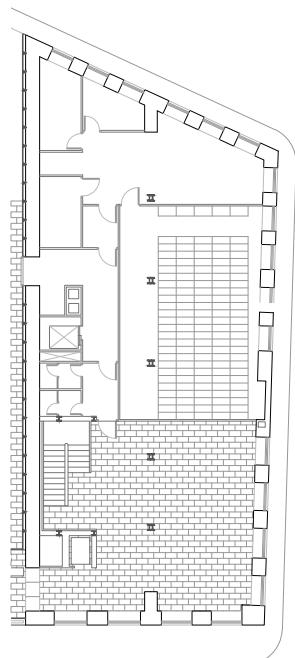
Planta baja del Archivo de Salvador Pérez Arroyo. Elaboración propia.
